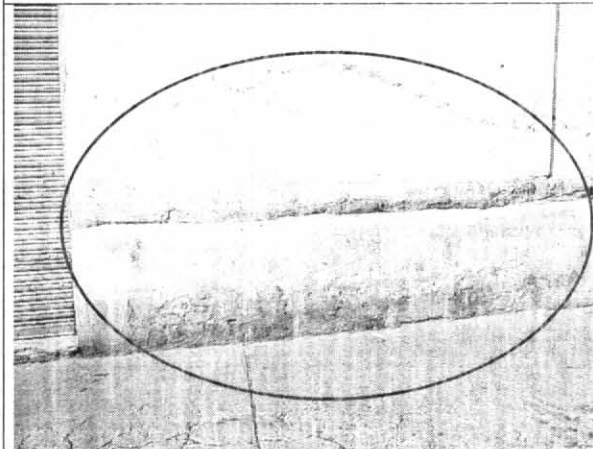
Desprendimiento de acabados en la fachada del inmueble.
